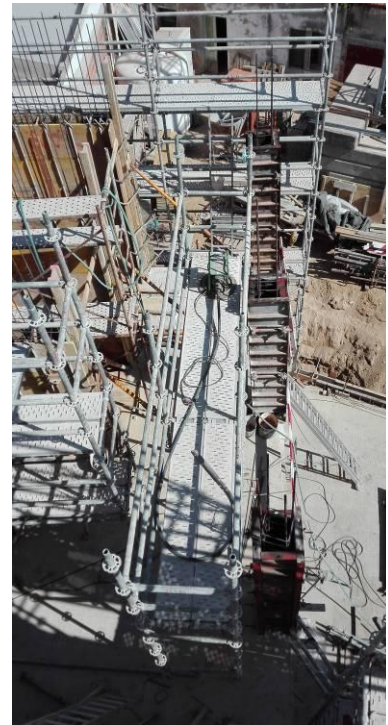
Execução da armadura e betonagem de laje e vigas do piso 1
